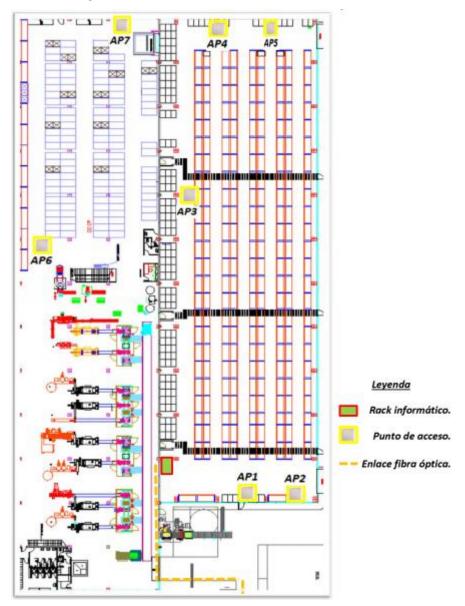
Plano de las zonas EDI y NET con la ubicación de los Access Point
